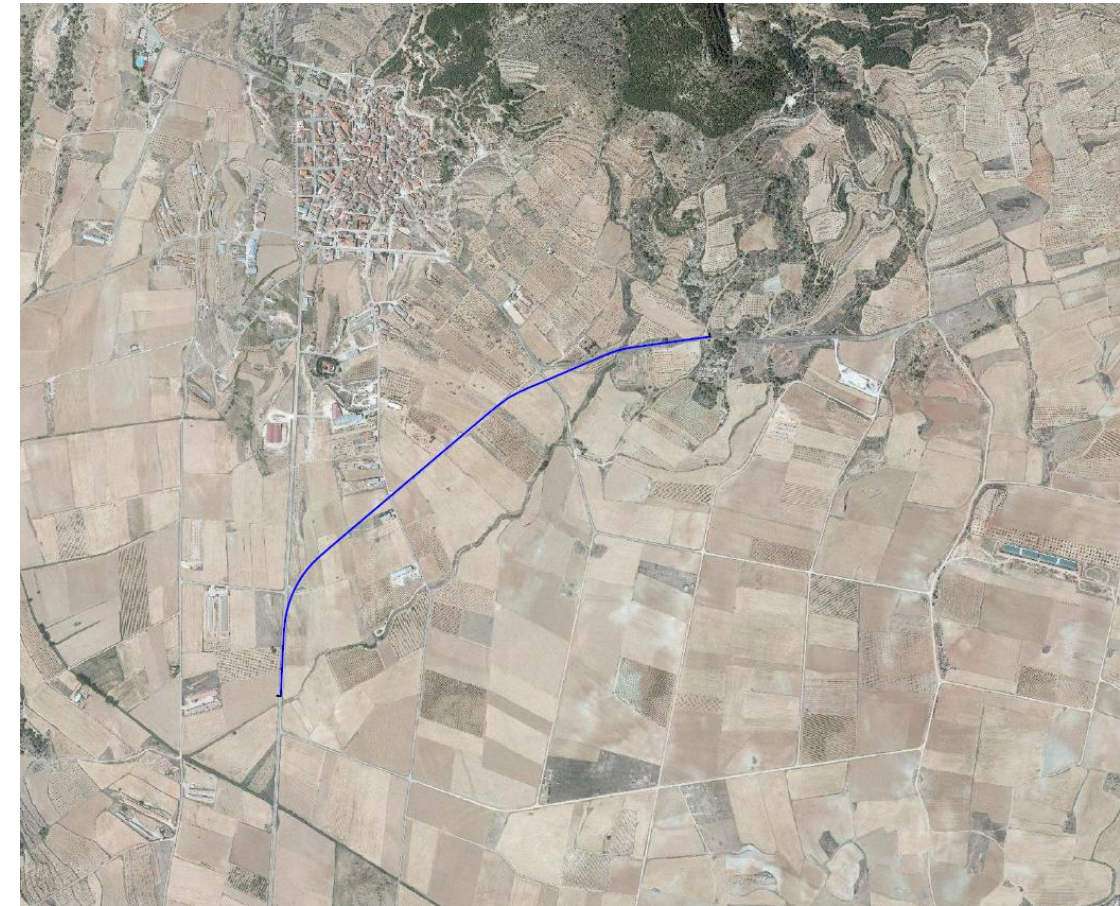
Croquis del trazado de la variante. Fuente: Elaboración propia.
